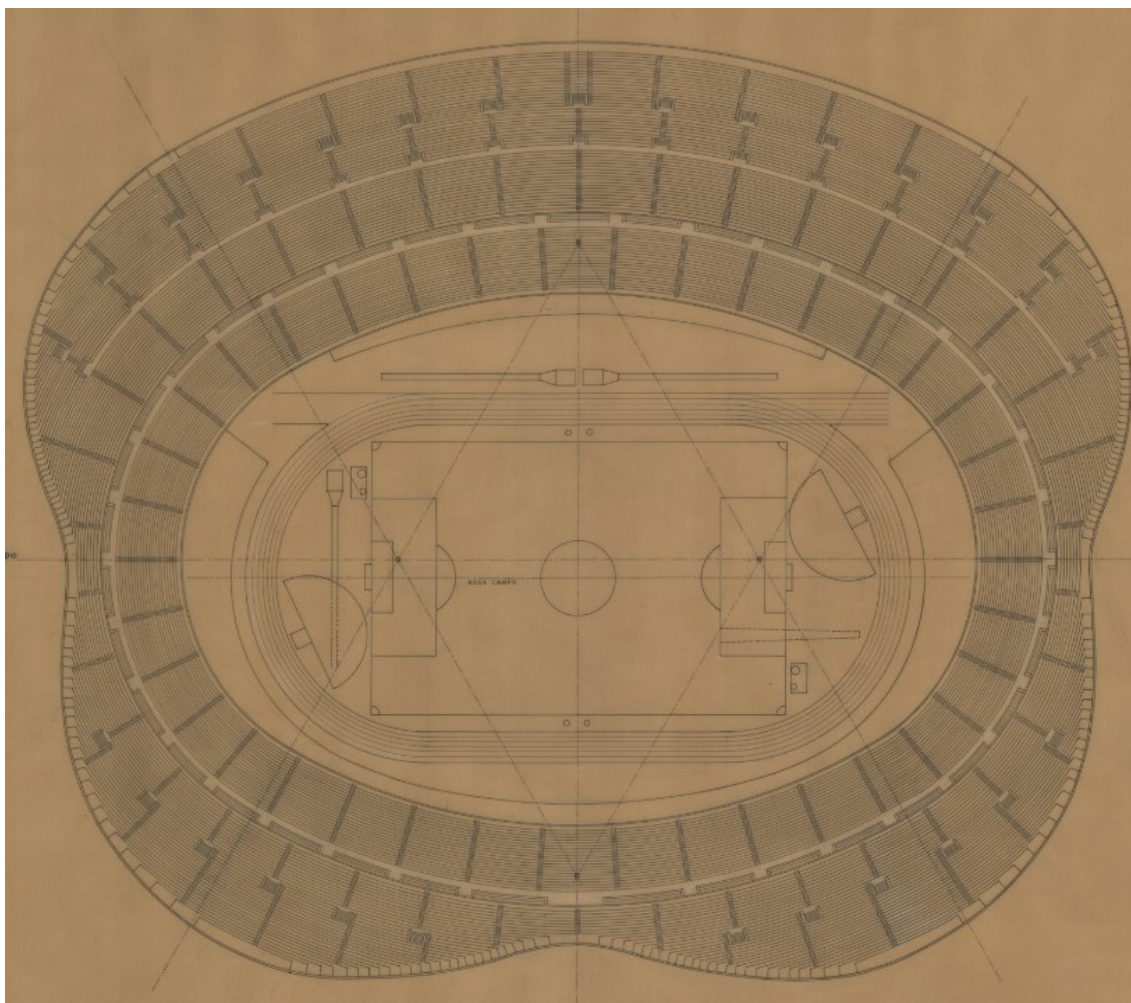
Luigi Moretti. Pianta di progetto di uno stadio secondo i canoni dell'Architettura Parametrica (1960)⁵⁴⁸.
